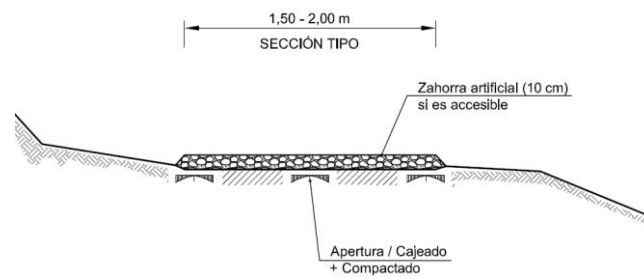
Sección tipo senda. Fuente: Elaboración propia.
